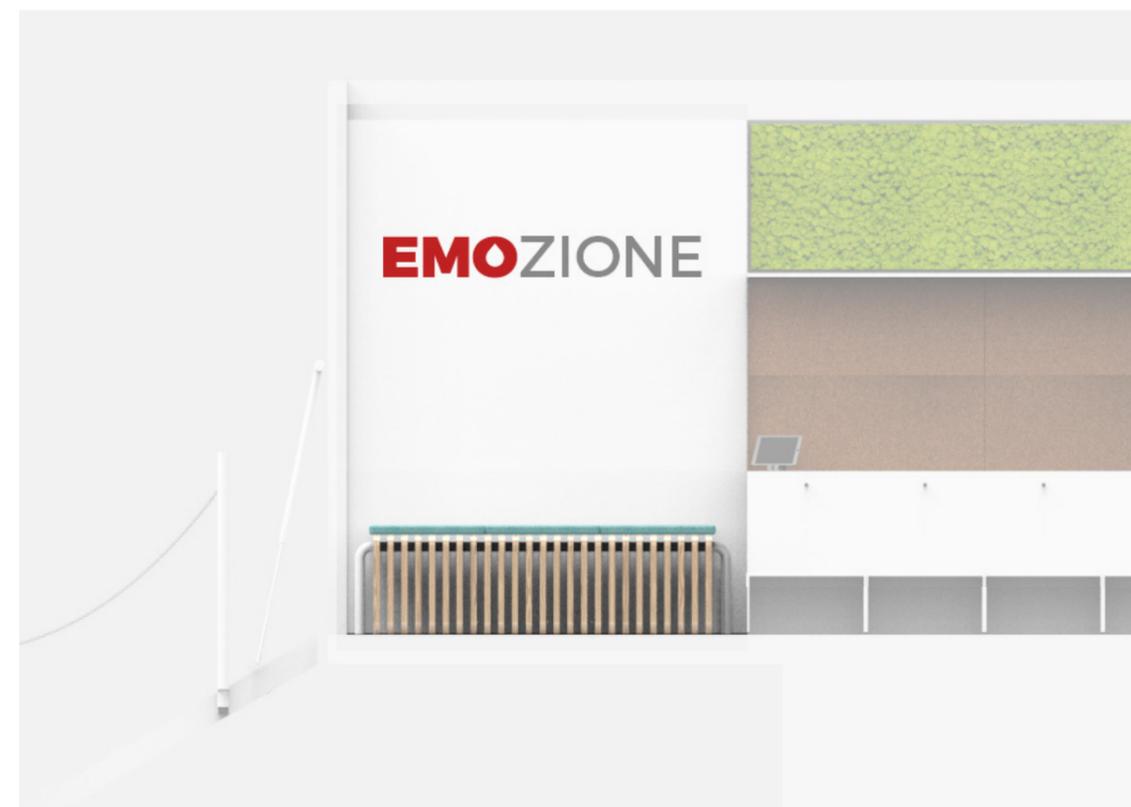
Prospetto sinistro nuova sala d'accettazione
